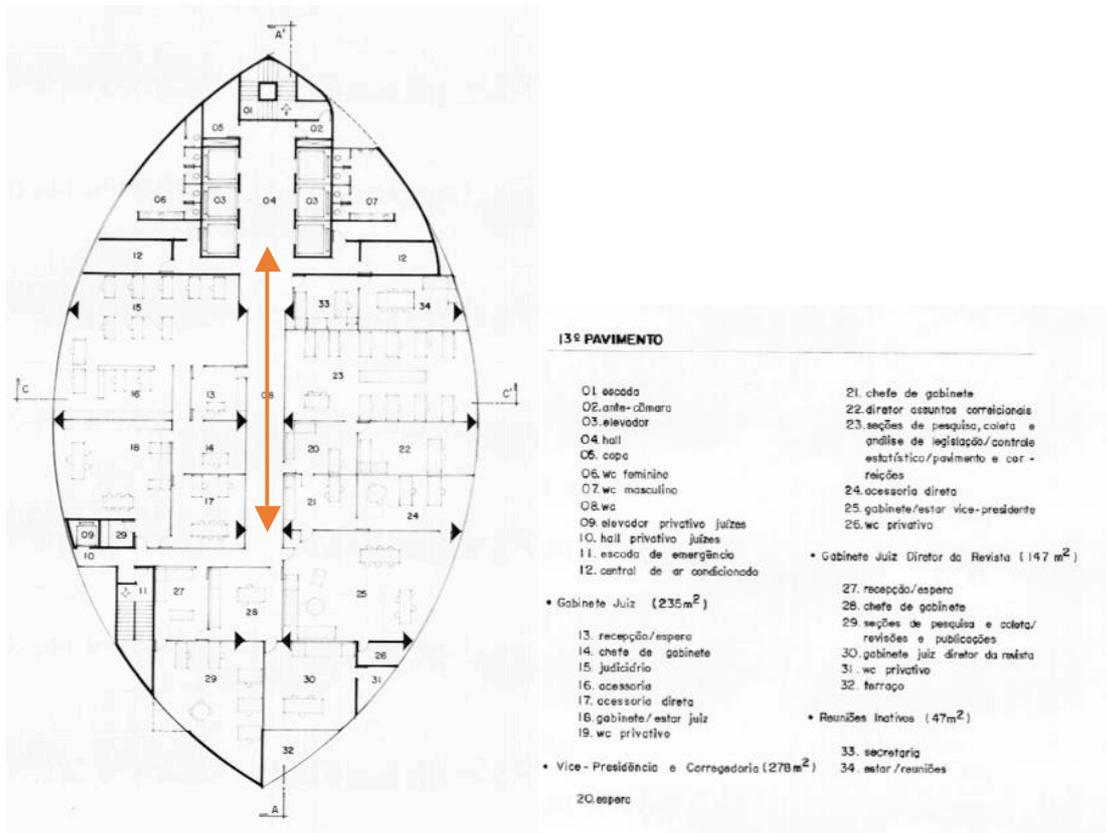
Planta Baixa do 13º Pavimento do Tribunal Federal, Fonte: Pontual Arquitetos, editado pela autora
